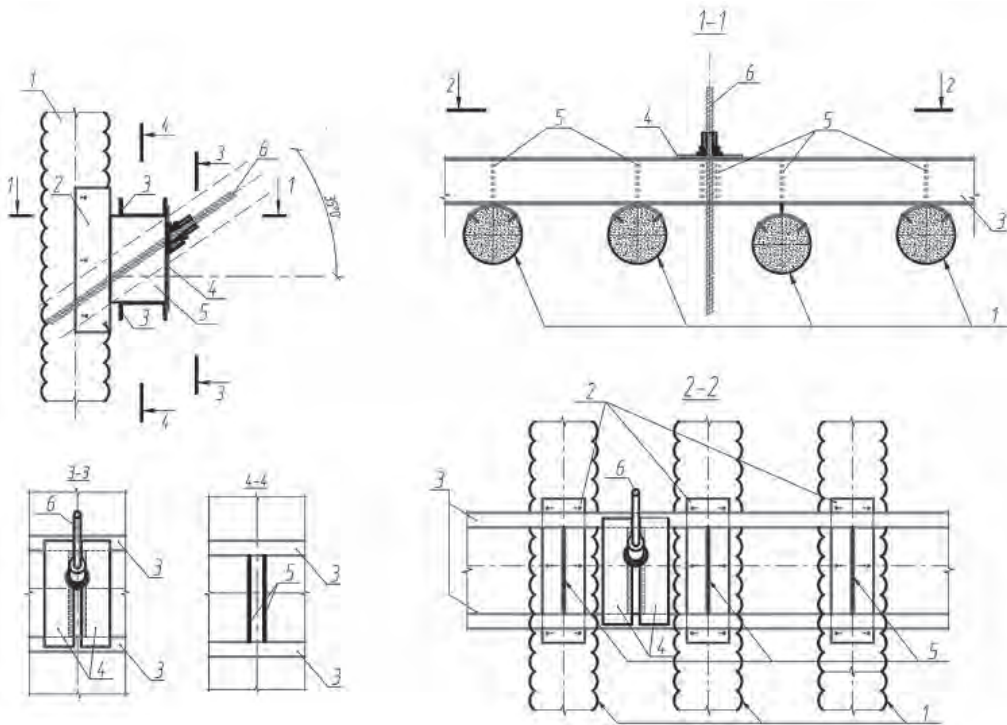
Схема узла крепления грунтовых анкеров к обвязочному поясу: 1 – буринъекционная свая ЭРТ; 2 – упор анкерного пояса; 3 – анкерный пояс из стальных профилей; 4 – стальная пластинка; 5 – ребра жесткости анкерного пояса; 6 – стержень из высокопрочной арматуры анкерного пояса; 7 – узел крепления стыка анкерного пояса
